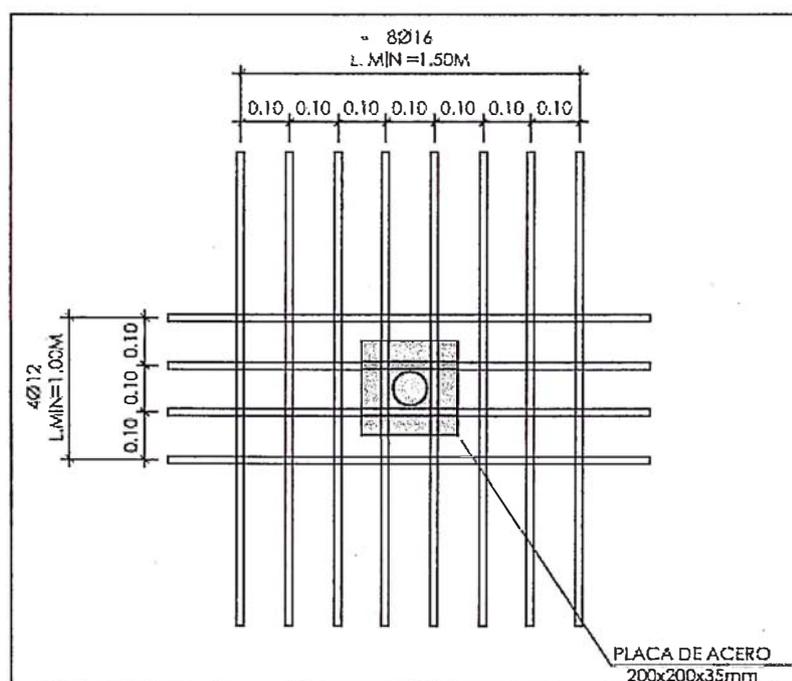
Acero de refuerzo adicional en zona de colocación de anclajes activos a separación horizontal de 1.50 m.
